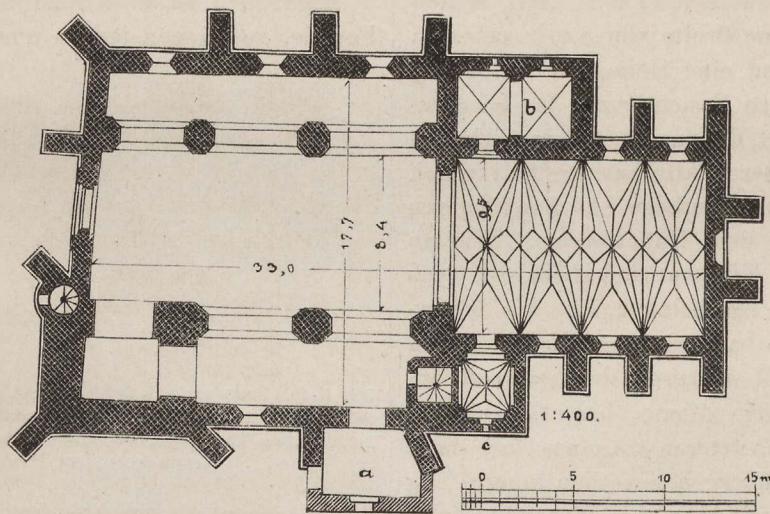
Neuenburg. Grundriss der kath. Pfarrkirche.
